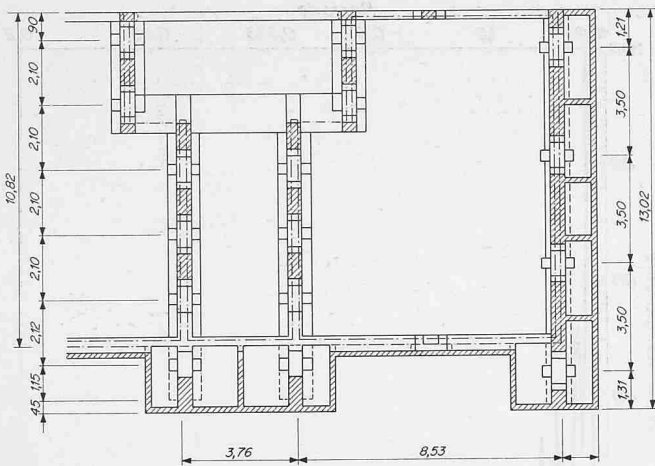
(oben). Ausschnitt aus dem Grundriss der Pestalozzi-Schule
